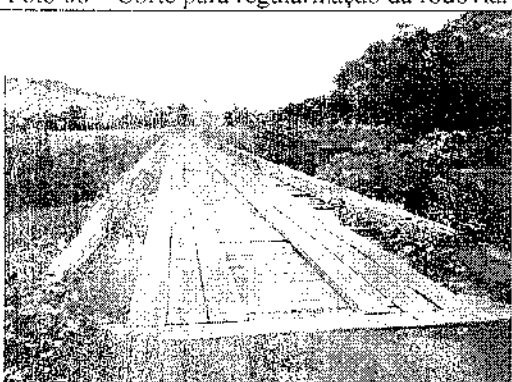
Ponte ob a qual será construída uma passagem de fauna.
